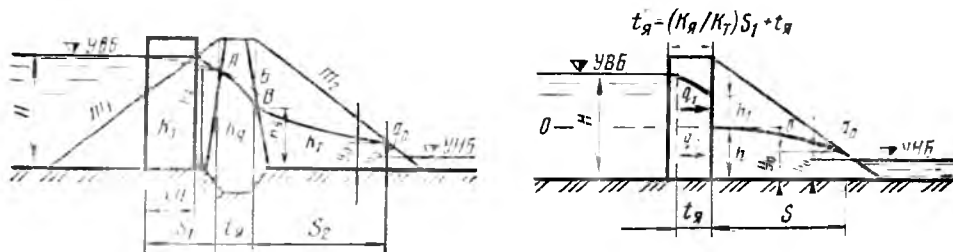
Схемы к расчету грунтовых плотин по методу Н. П. Розанова.
